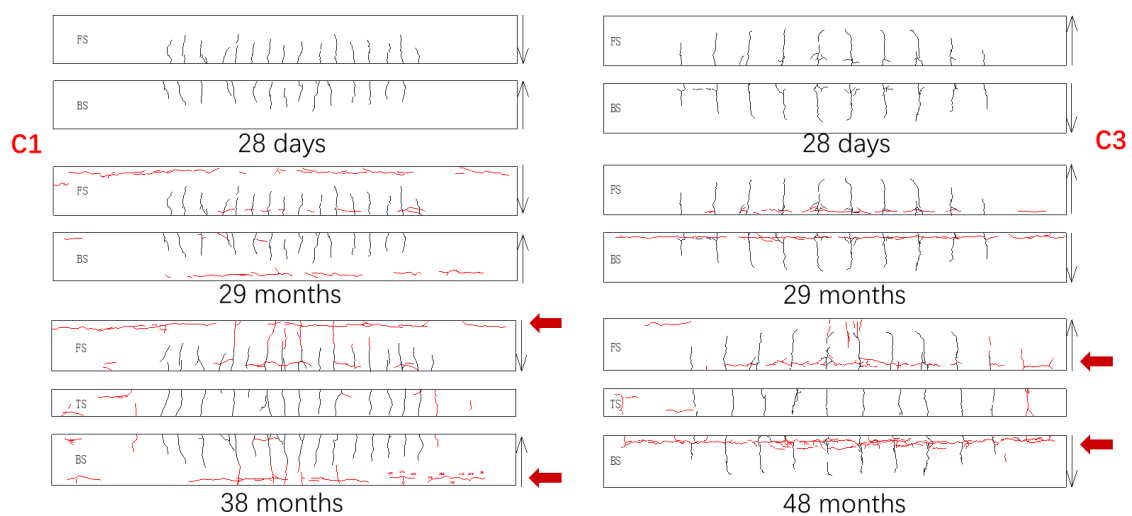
Carte de fissuration des poutres C1 et C3
